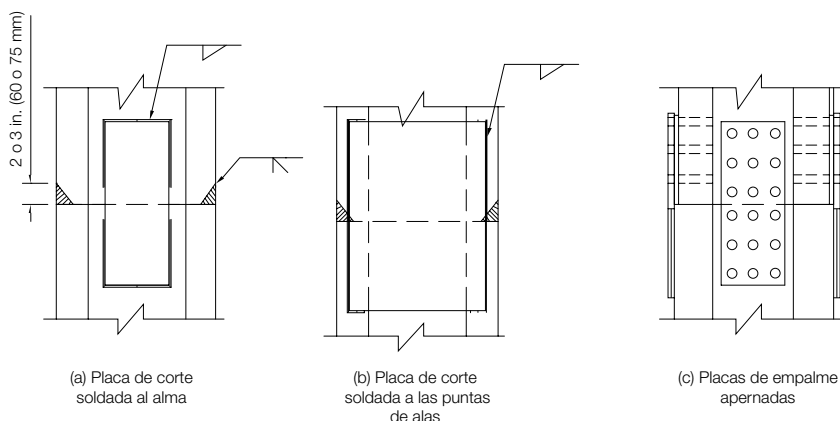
Empalmes alternativos que minimizan las tensiones de restricción en la soldadura.
